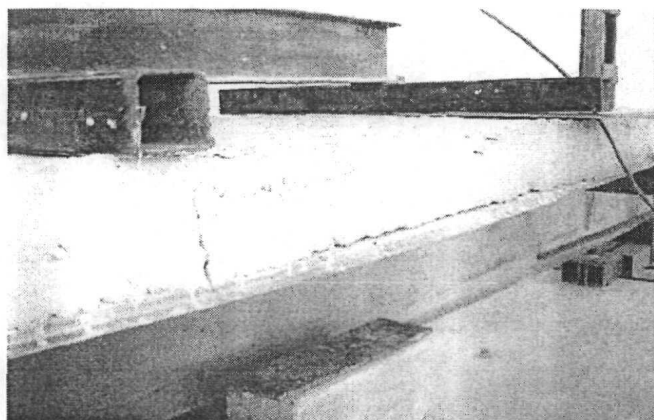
Agrietamiento bajo apoyo izquierdo y pérdida de adherencia en la parte central del elemento
